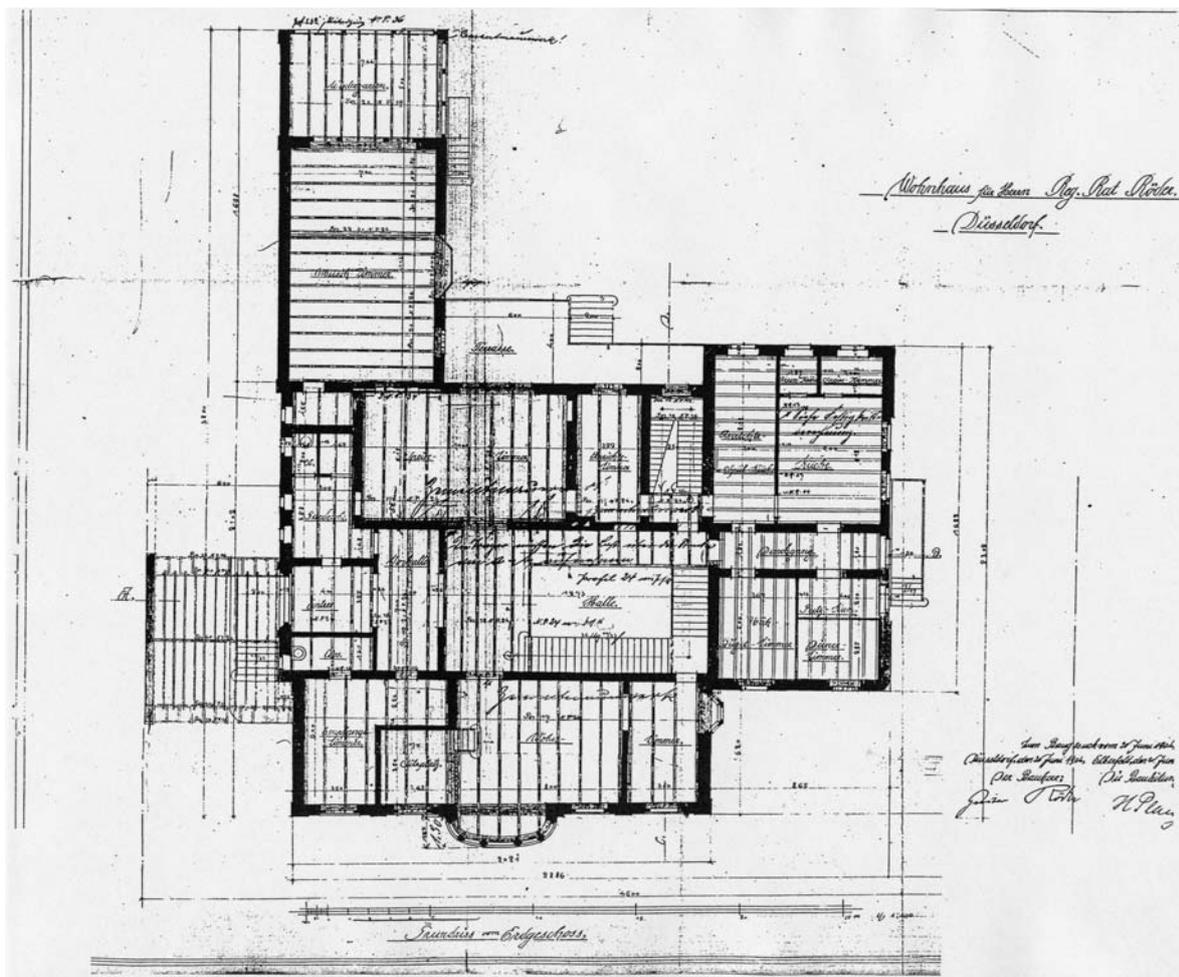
H. Plange, Grundriss Erdgeschoss ohne Änderungen während der Bauphase, Juni 1904
